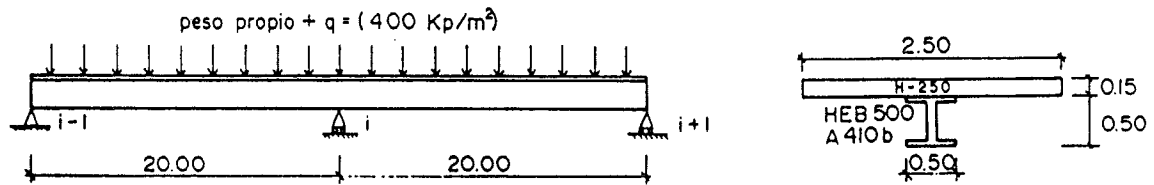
Estructura mixta considerada para analizar la influencia de la fisuración en el cálculo de flechas.
